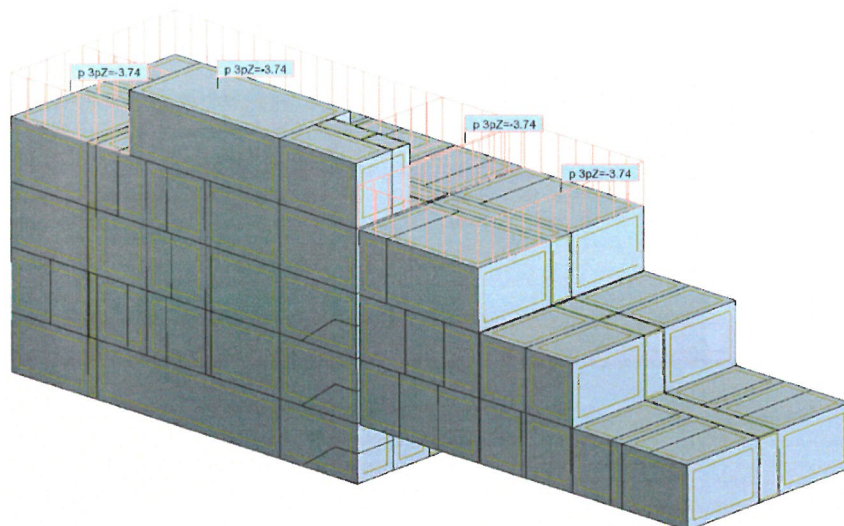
Przypadek obciążenia stałego od dachu intensywnego.
